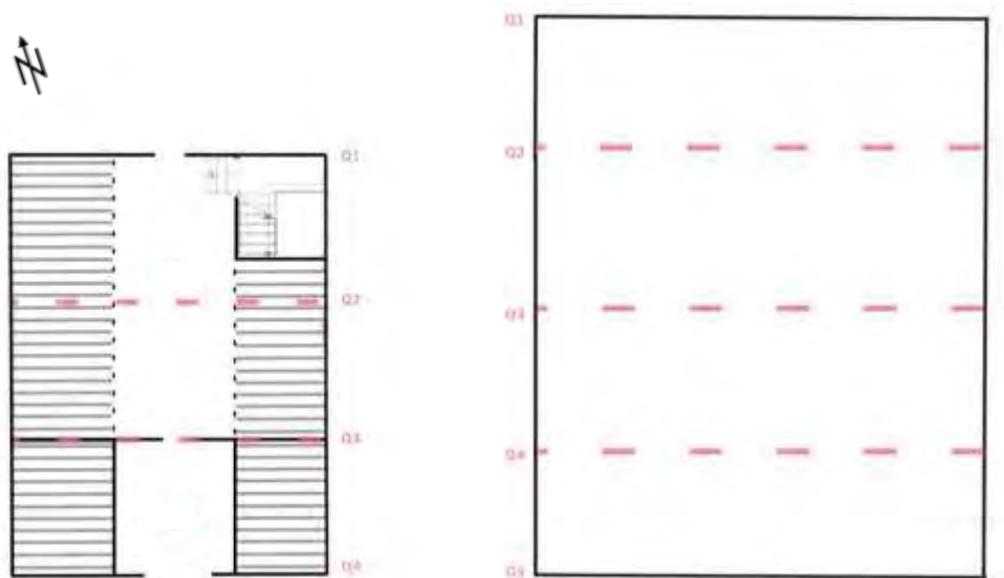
Schematischer Grundriss, Dachwerk des Wohnteils und der Ökonomie. Bearbeitung IBID.
